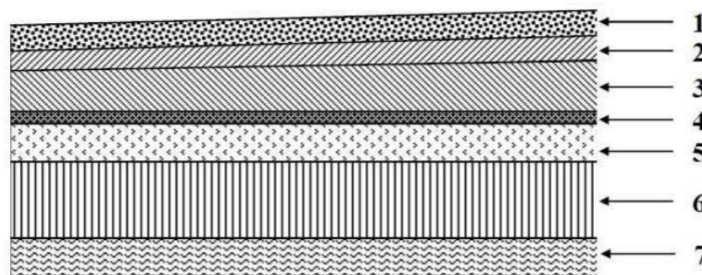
Coupe verticale du plancher terrasse inaccessible.
